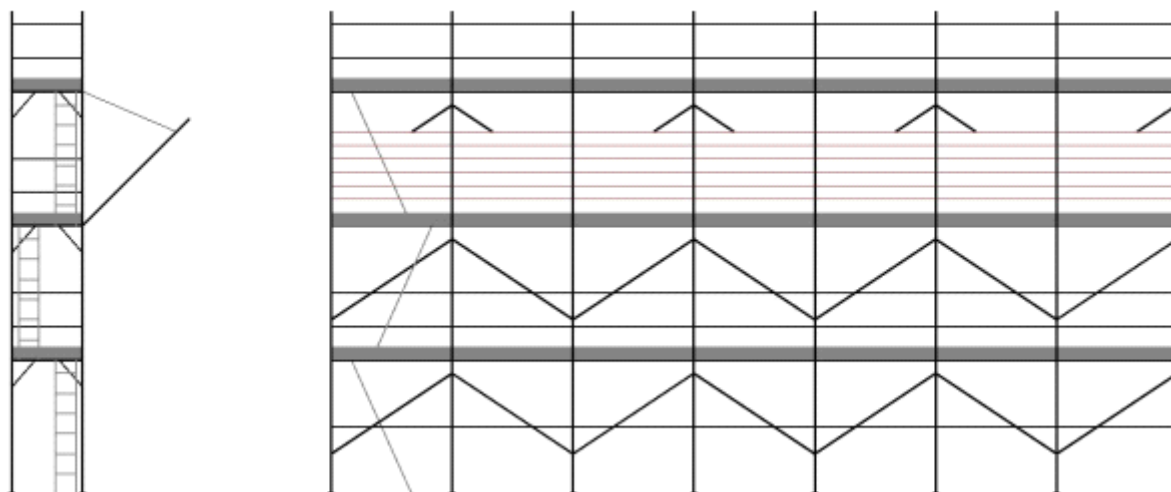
Prospetto e vista laterale tipo Ponteggio da montare
